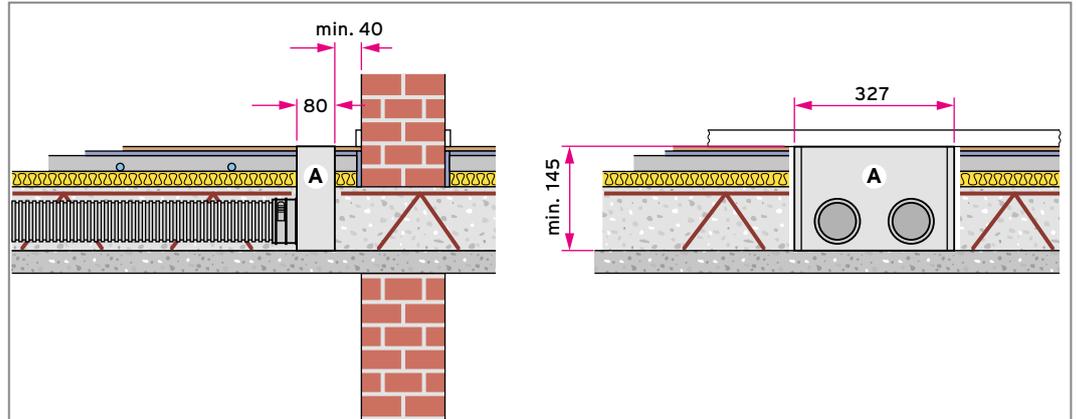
Rechteckiger Luftauslass, Bodenmontage - Verlegung in der Rohbetondecke
